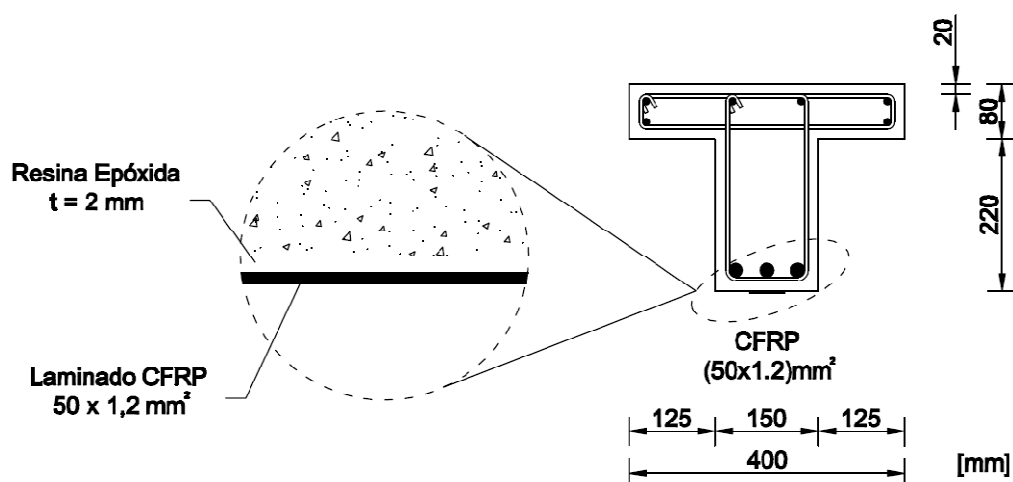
Pormenorização transversal do sistema de reforço testado nos modelos TSC2 e TSC3
